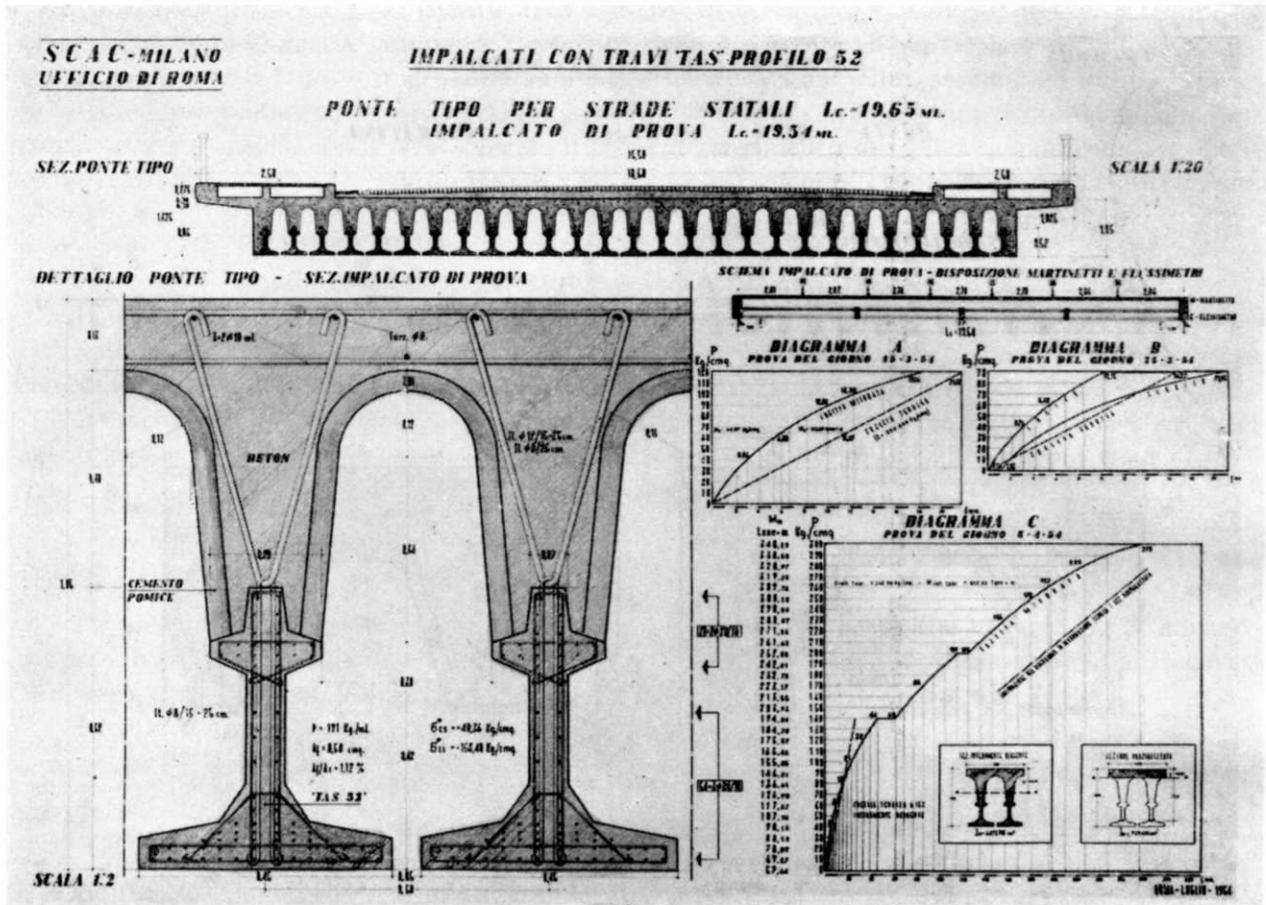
Sezioni di ponte tipo e dell'impalcato sperimentale con T.A.S. profilo 52. — Schema dell'impalcato sperimentale e diagrammi delle prove di carico.
